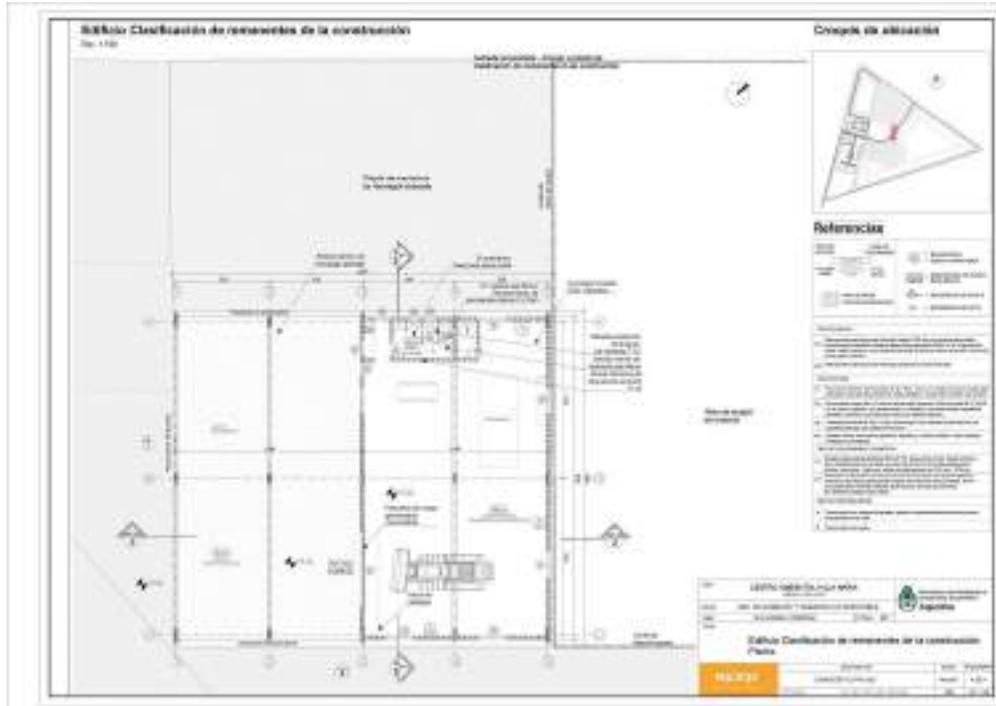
Villa María - Sector Áridos - Planta de Arquitectura.
